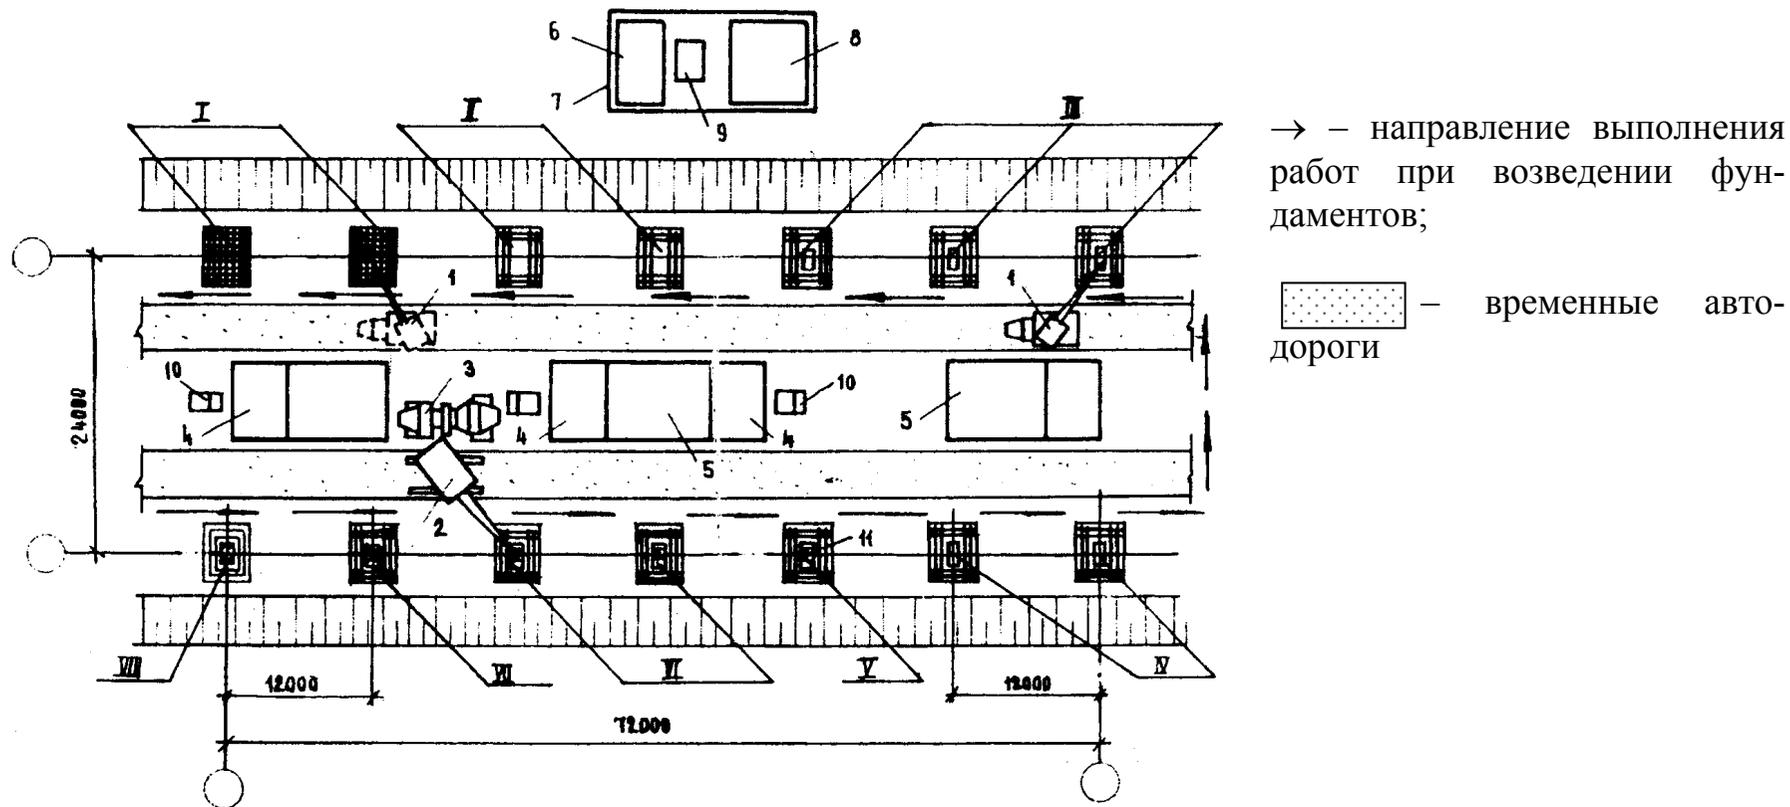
Схема устройства монолитных фундаментов под колонны при укладке бетонной смеси с помощью стреловых самоходных кранов (варианты 1,2):
